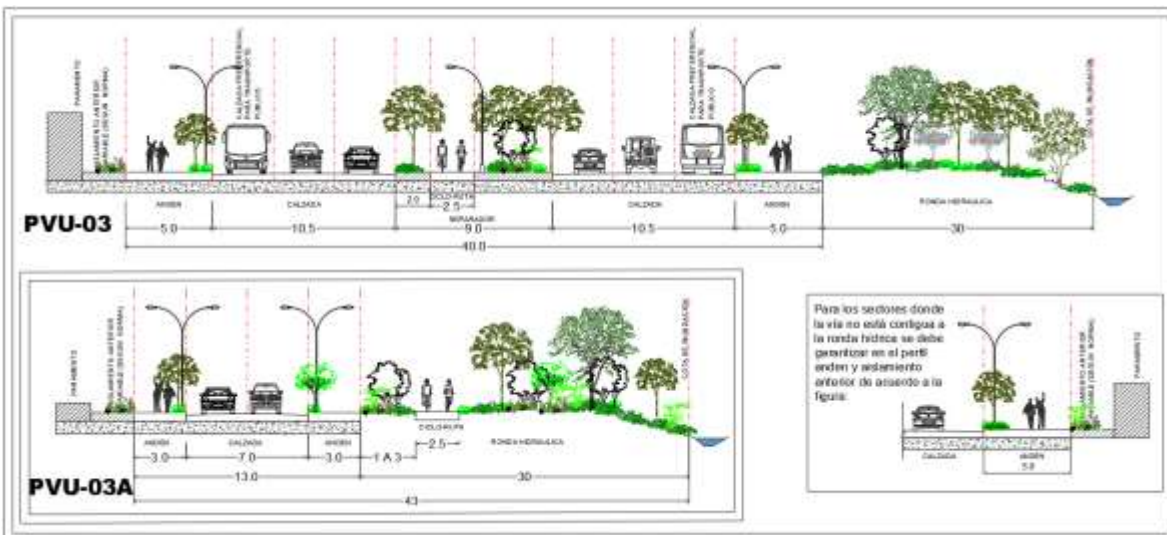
Perfiles viales PVU-03 y PVU-03A.
